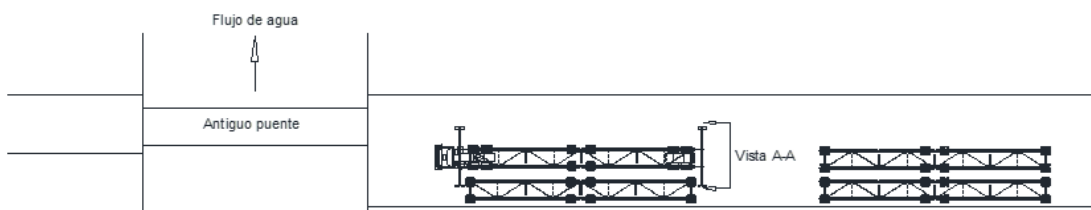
Elevación y descenso de las vigas hasta el dolly mediante los pórticos
